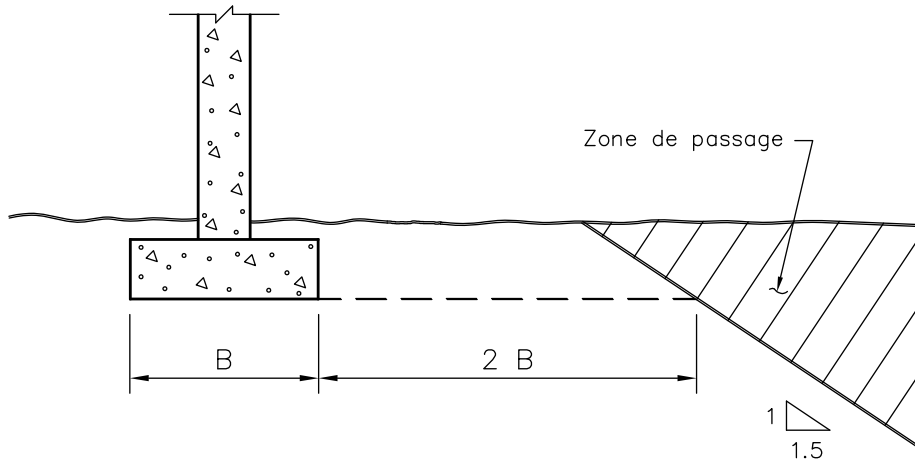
Zone de passage d'un conduit ou d'un groupe de conduits près d'une pile
